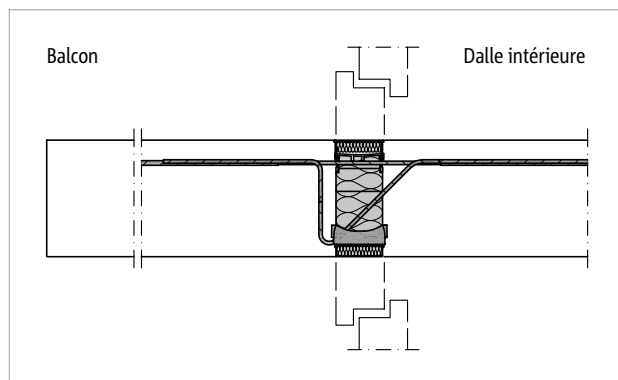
Schöck Isokorb® T Type CK : balcon avec système de mur rideau
